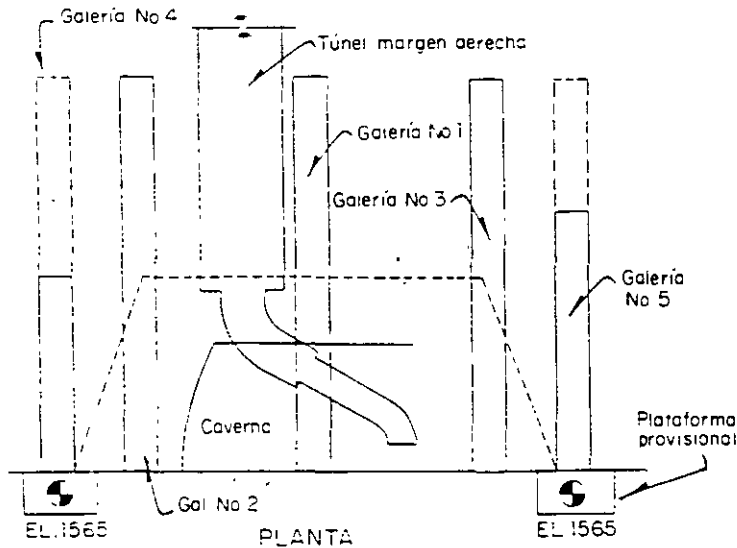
Proceso constructivo de galerías para traves de anclaje
